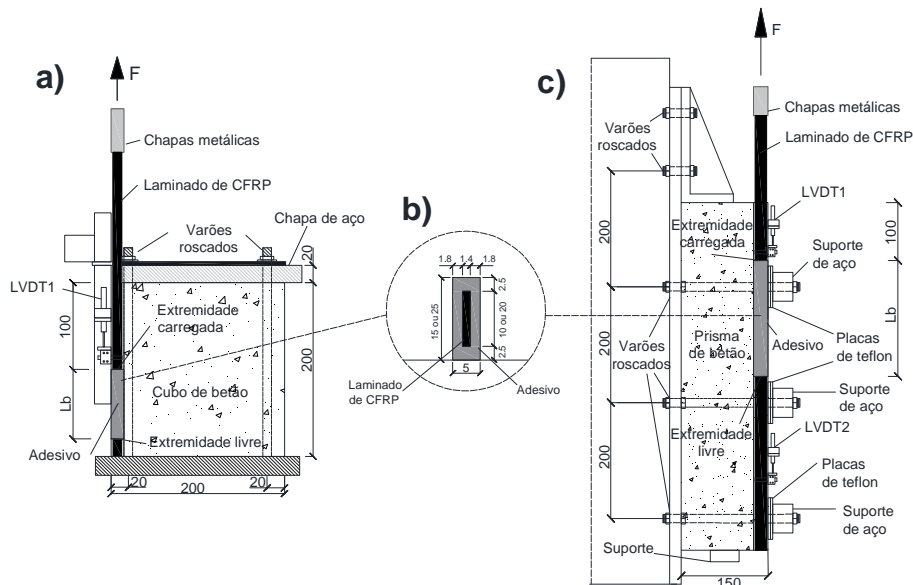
Geometria dos provetes e configuração de ensaio: (a) provetes cúbicos (secção transversal); (b) detalhe do entalhe; (c) provete prismático (secção transversal).
